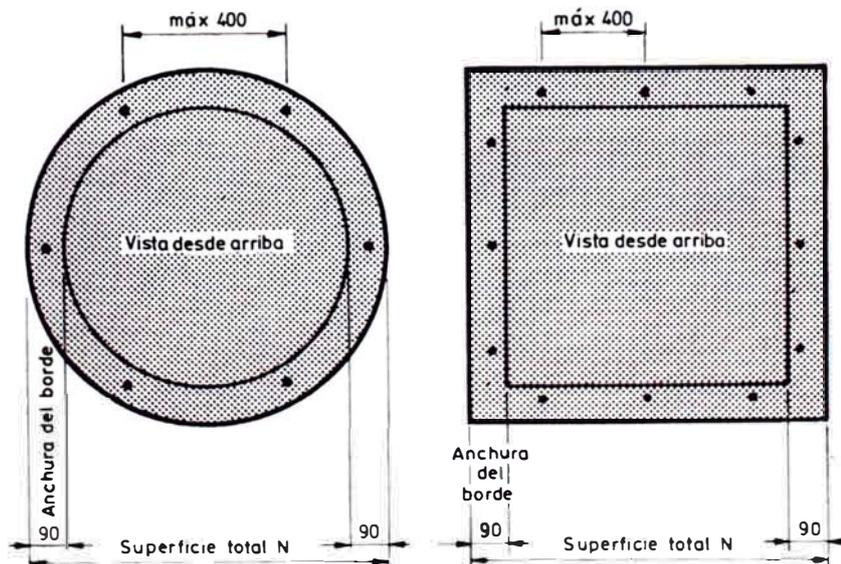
Planos de planta esquema, claraboya circular y rectangular.
